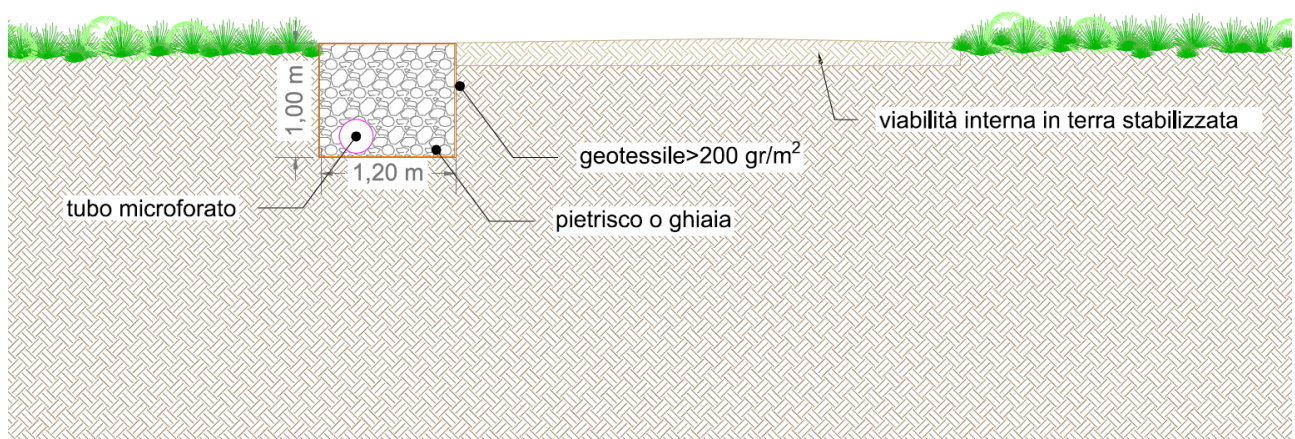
Particolare costruttivo in sezione della trincea drenante
